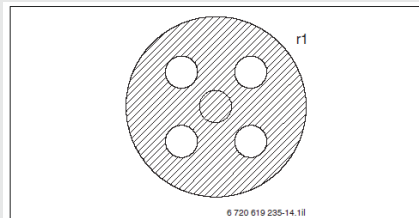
Sondenquerschnitt einer Doppel-U-Sonde mit Verfüllrohr
